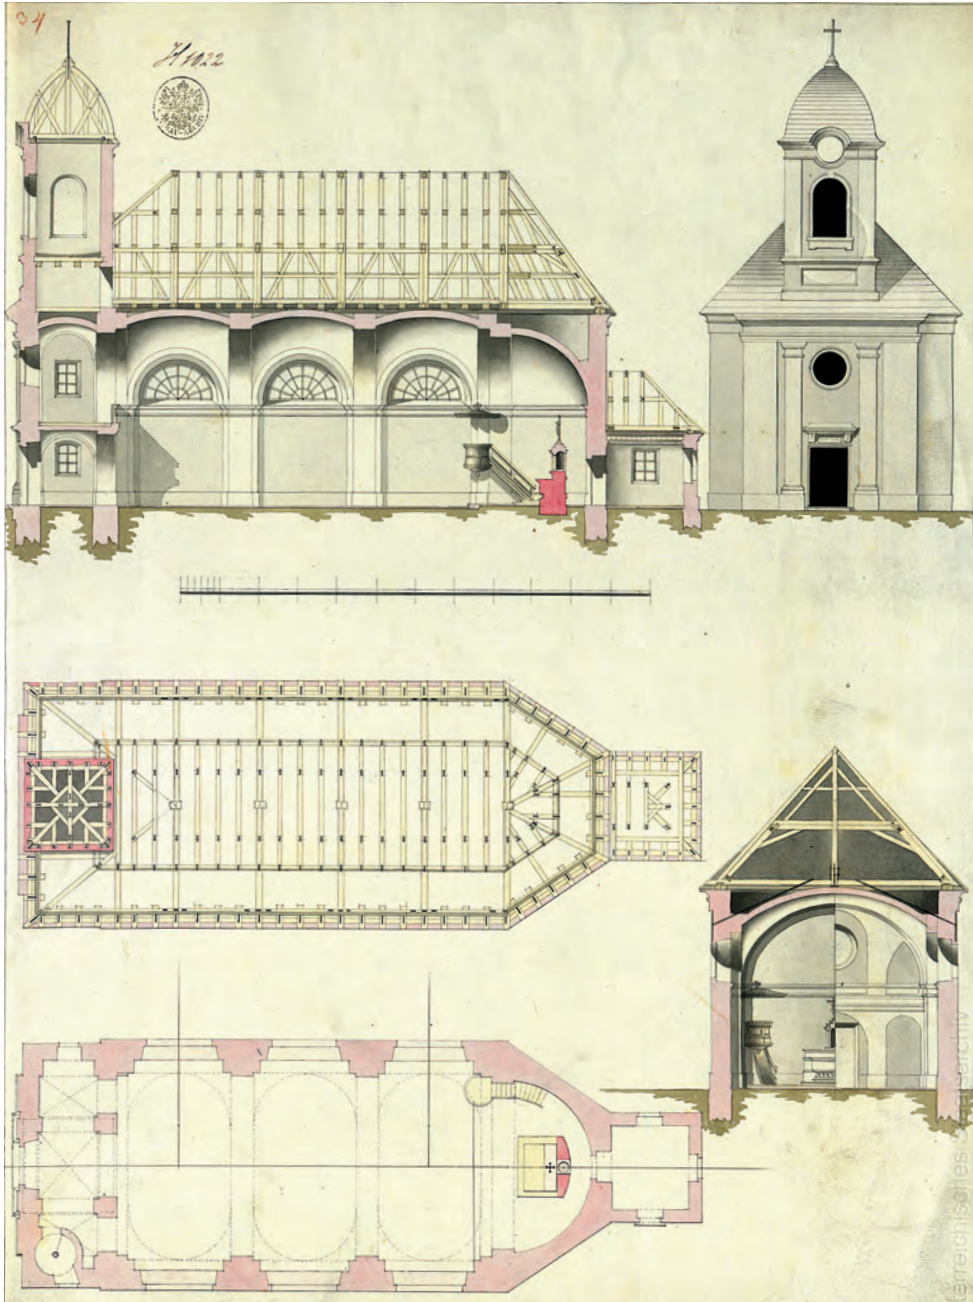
Josephinische Musterkirche, Längsschnitt, Fassadenaufriss, Dachstuhl, Querschnitt und Grundriss, um 1783 (Wien, AVA, Plansammlung I, Mappen 632–635, Inv.-Nr. I c)
